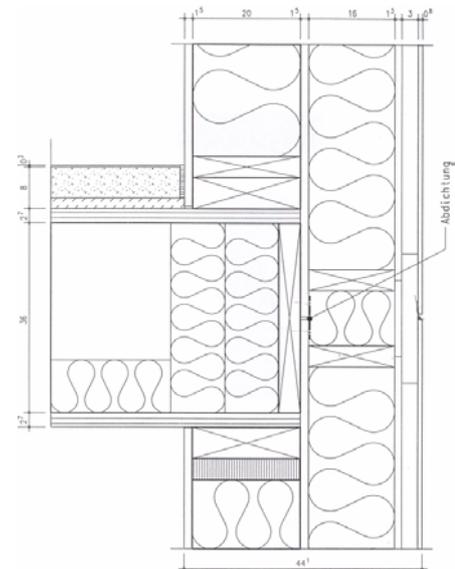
Detailplan Fassade mit Anschluss Zwischendecke
